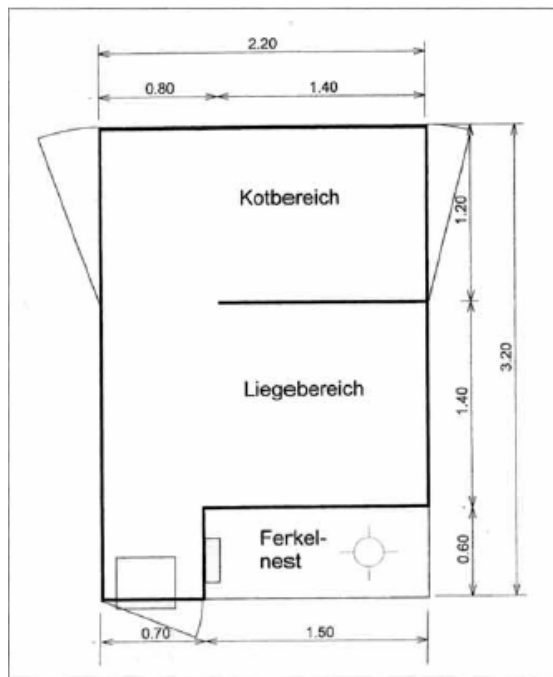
Grundriss der FAT2-Bucht (Schick und Weber 1996)
